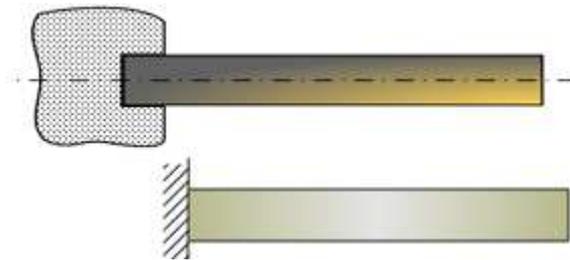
Viga en voladizo (CORNEJO, 2015)
